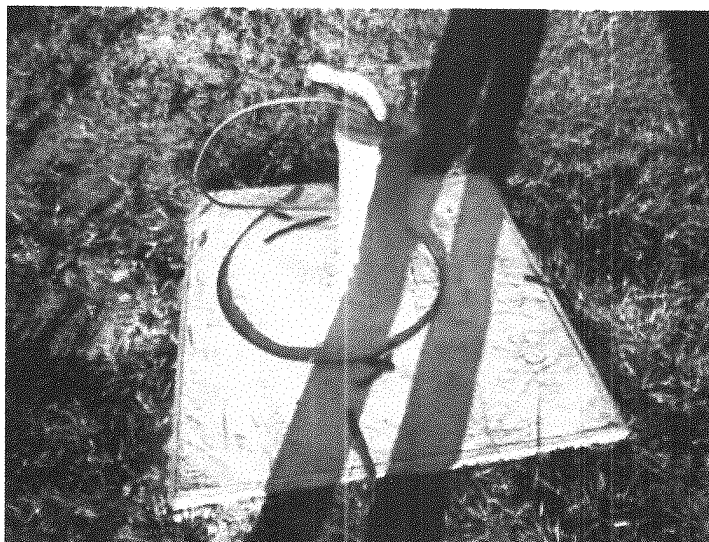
Modelo de laje de proteção em concreto e coluna de revestimento e tampa protetora.
